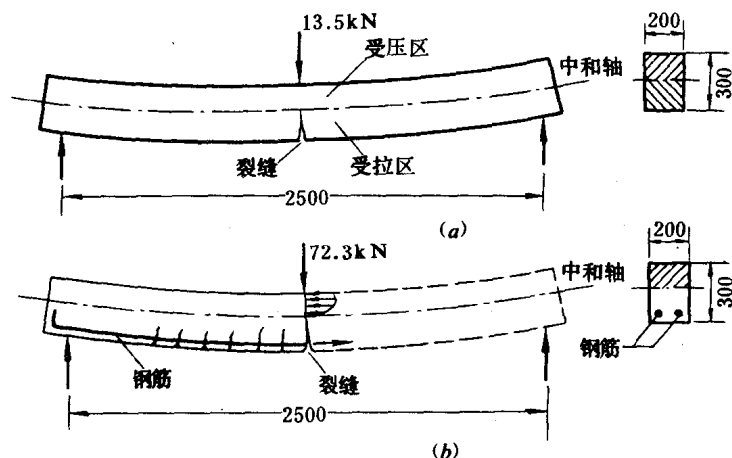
混凝土及钢筋混凝土简支梁的承载力
